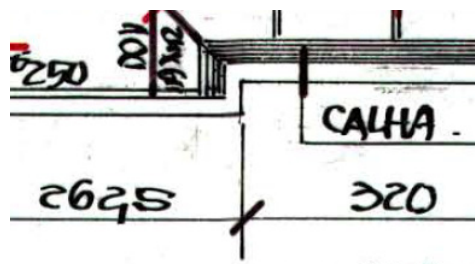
DETALHE DE CALHA E BEIRAL – PLANTA DE COBERTURA: COBERTURA 03
